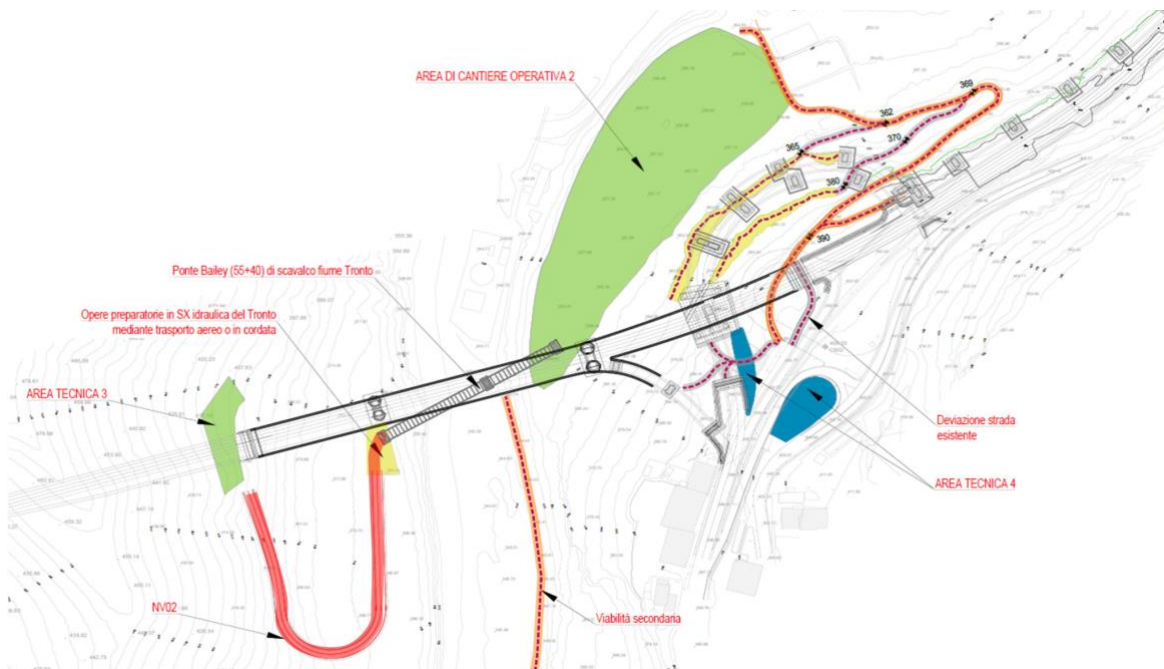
Dettaglio accessibilità in fase di cantiere – area svincolo
